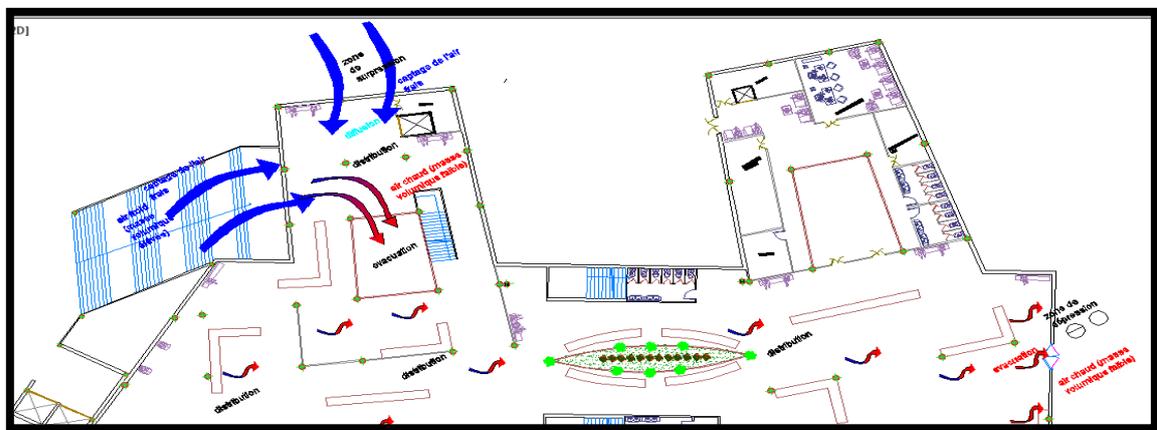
plan de fondation qui illustre la ventilation naturelle traversante.
